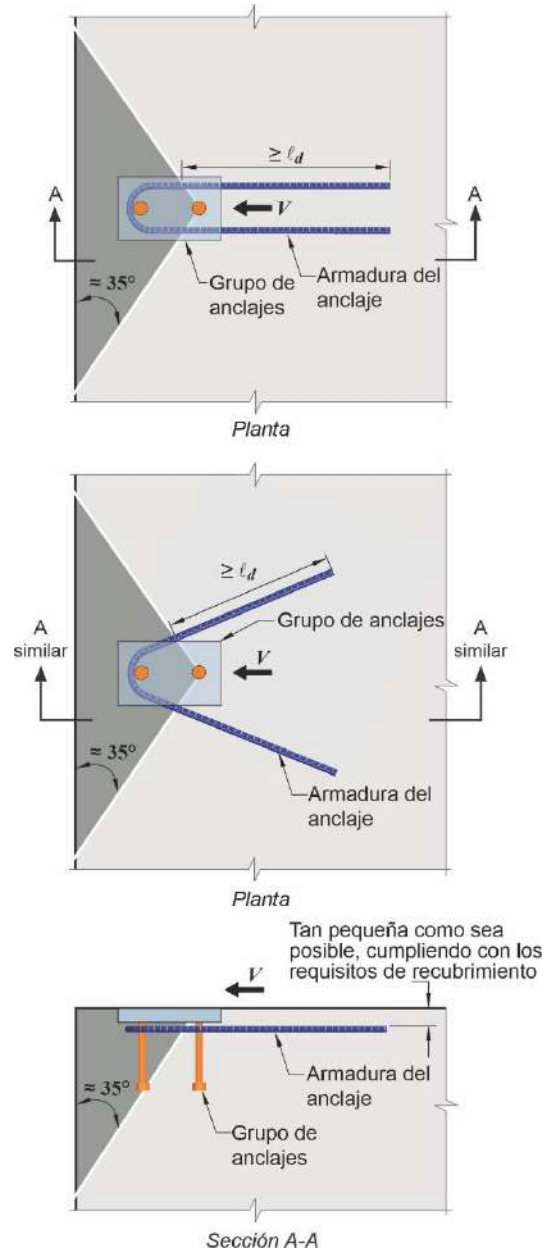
(i). Armadura del anclaje por corte en forma de horquilla
